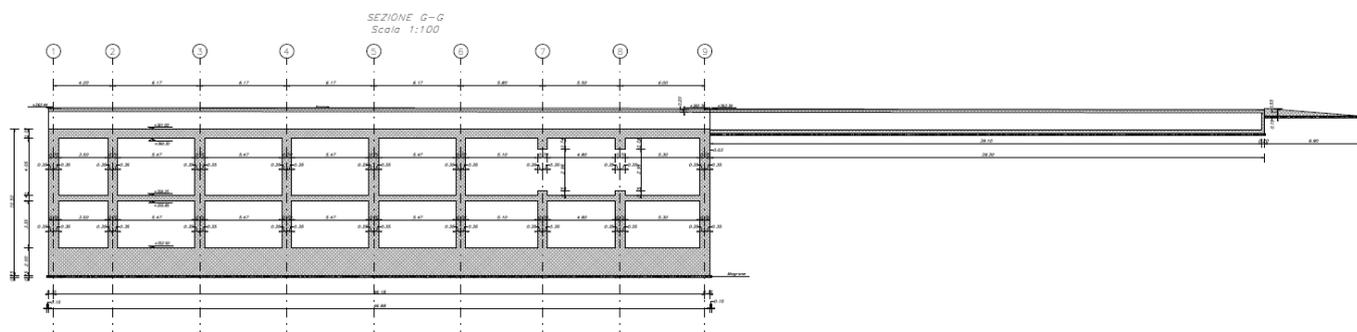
Pianta quota sottopasso struttura in C.A.
